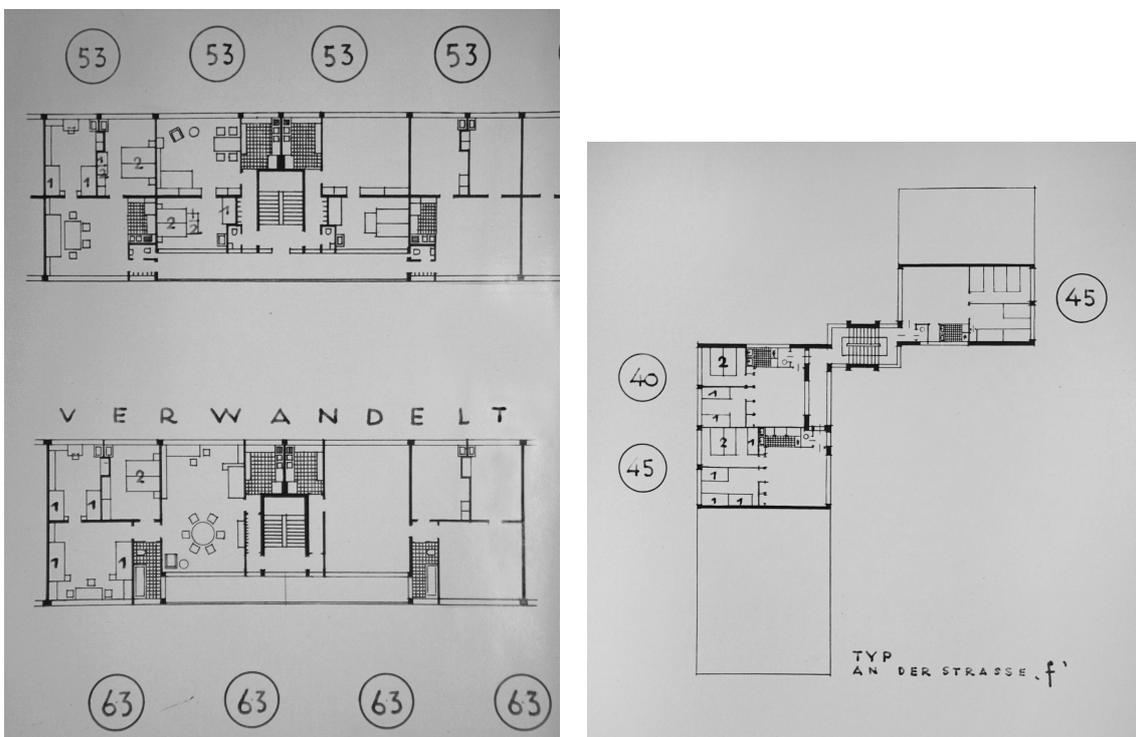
u. 46 Grundrisse Laubengangtyp u. Ecktyp, (vermutlich) für Wettbewerbseingabe, 1927/28
